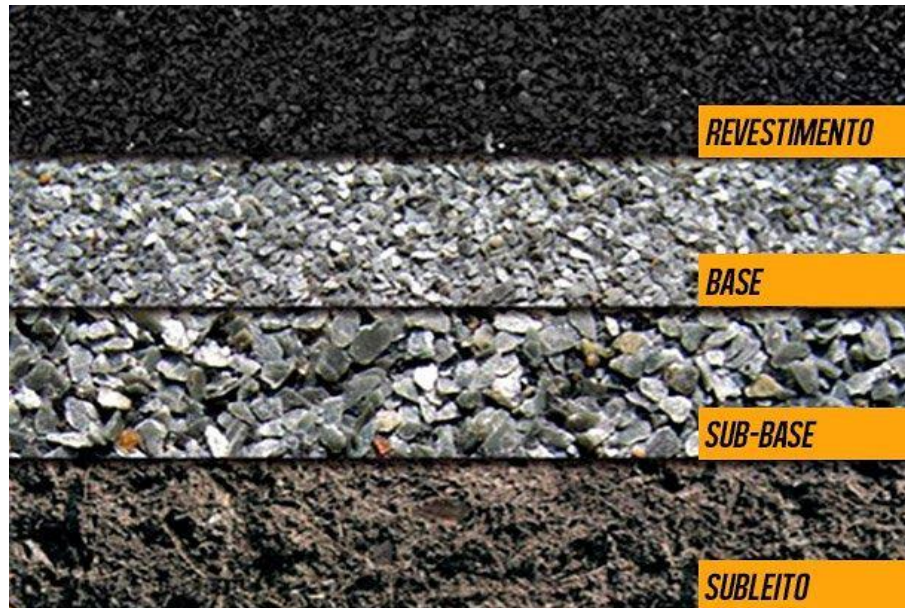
Camadas de um pavimento. Fonte Flatout (2017)
